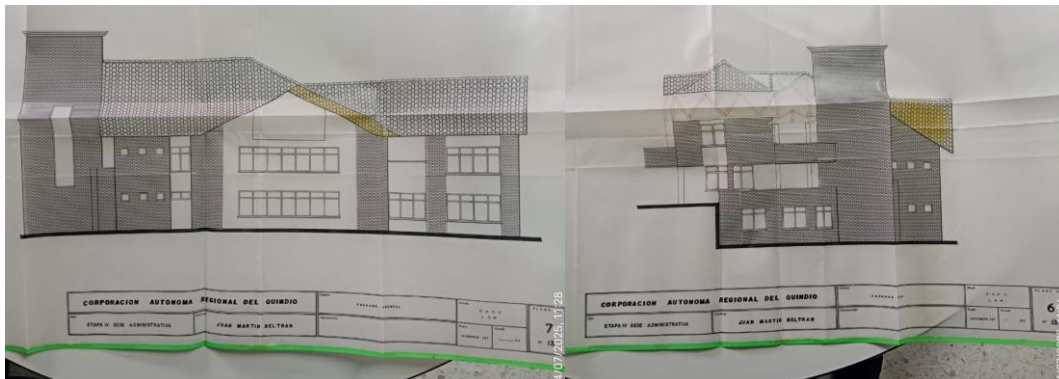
Planos Bloque 1 Administrativo CRQ sede Armenia
